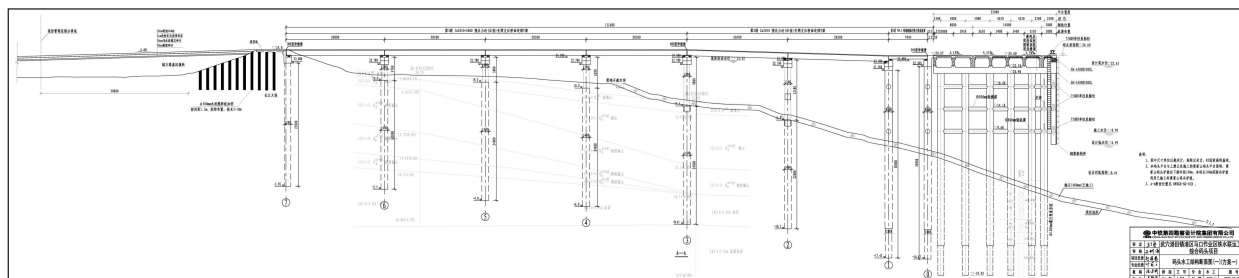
水工结构断面图(一)(方案一 推荐方案)
